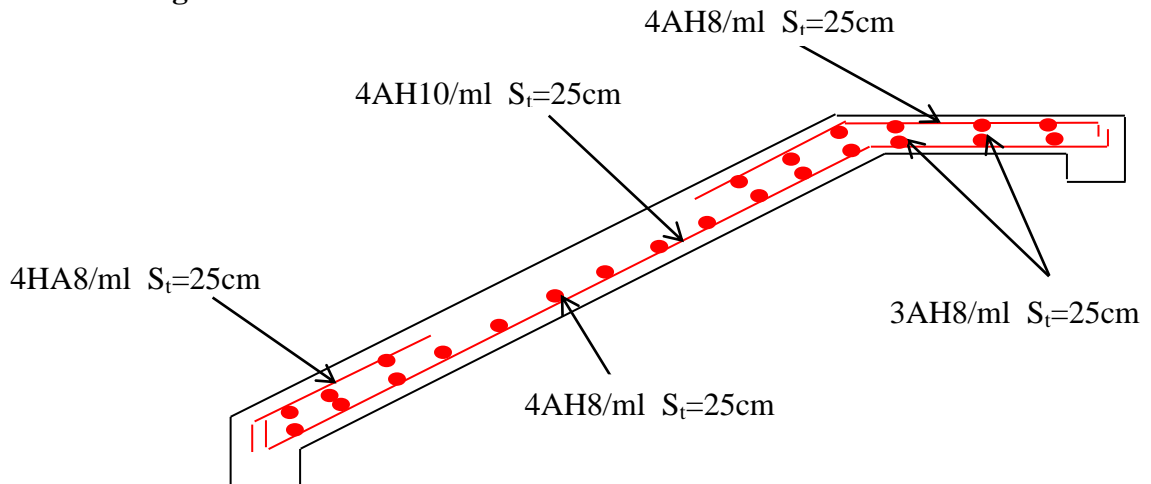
schéma de ferrailage de volée 1 E/Sol
